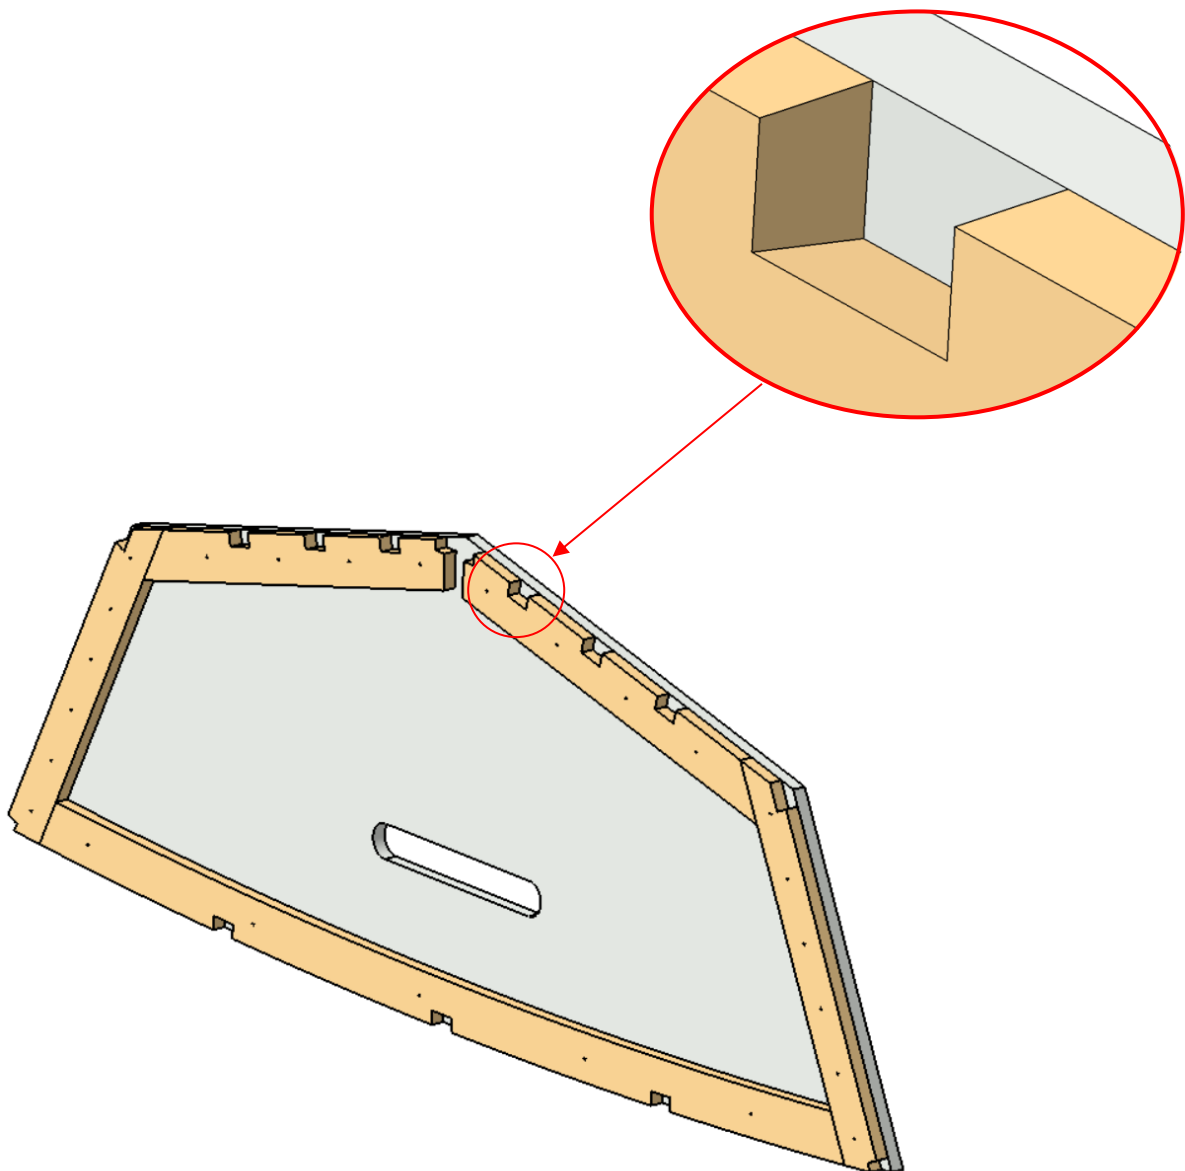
Detalle corte con ángulo. Fuente: propia
